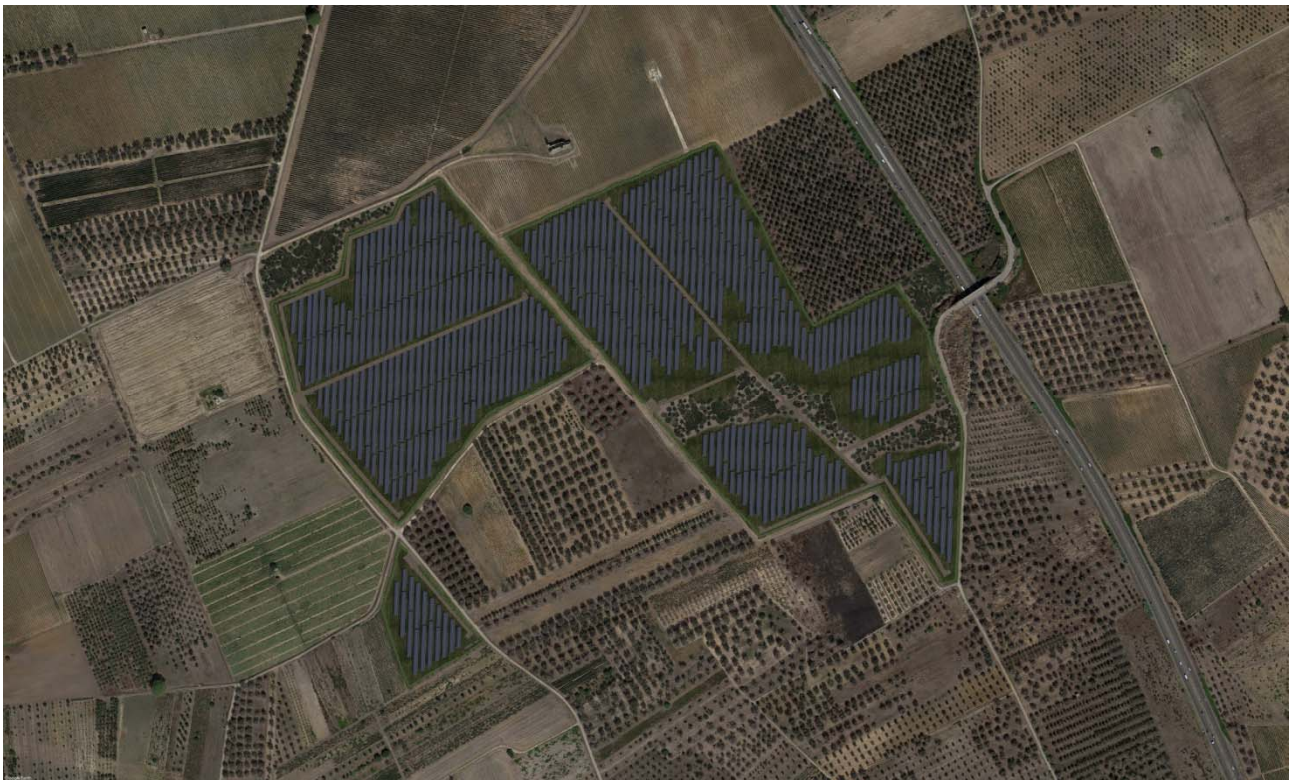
Fotoinserimento sotto-impianto FV-Bardi Vecchi – vista dall’alto
